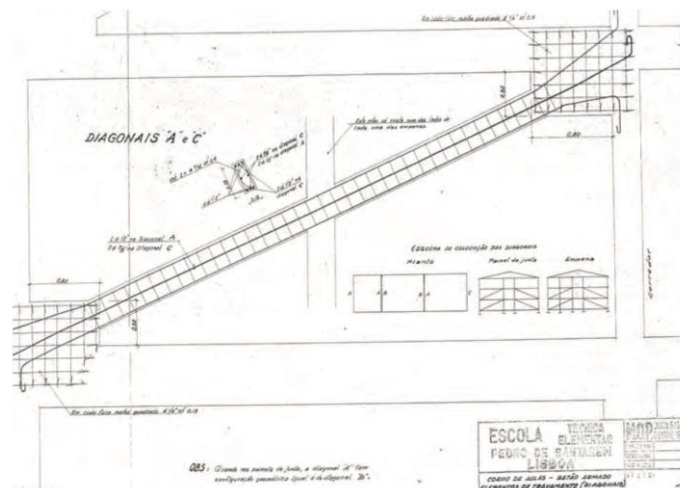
Pormenor das diagonais que servem para travar transversalmente a estrutura [23]
